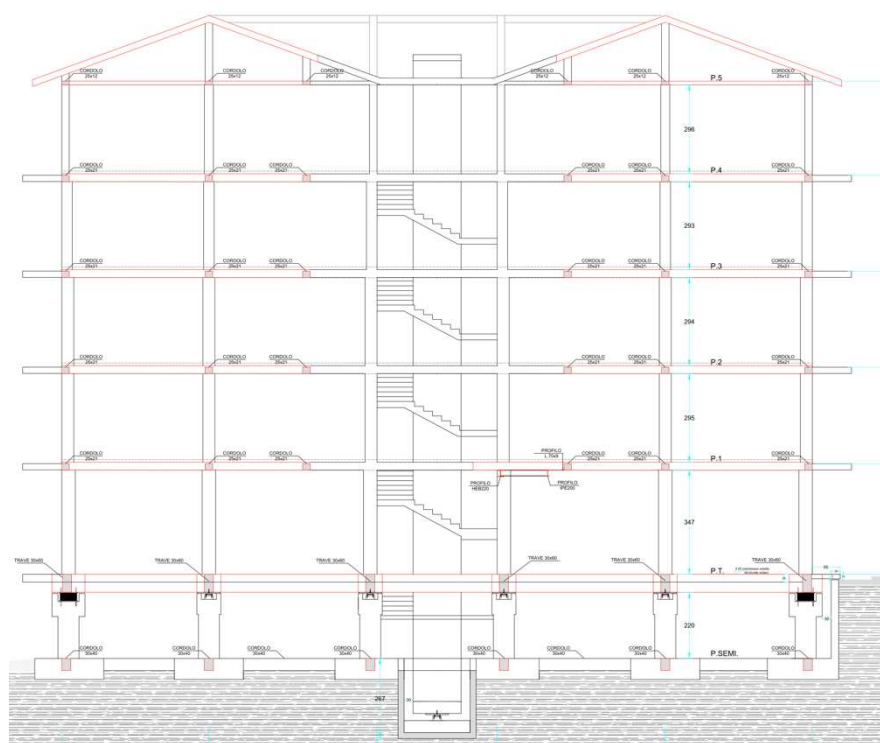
Carpenteria dell'edificio nello stato di progetto. Sezione A-A (scala 1:50).
